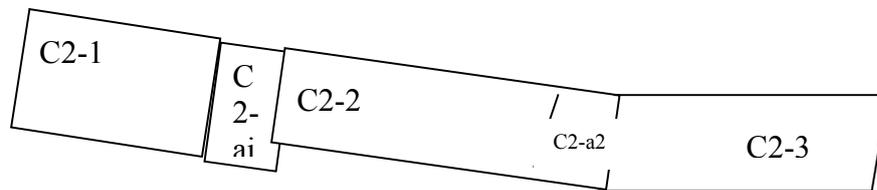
Denah Lantai 1 Bangunan C tanpa skala (Dok: pribadi)
